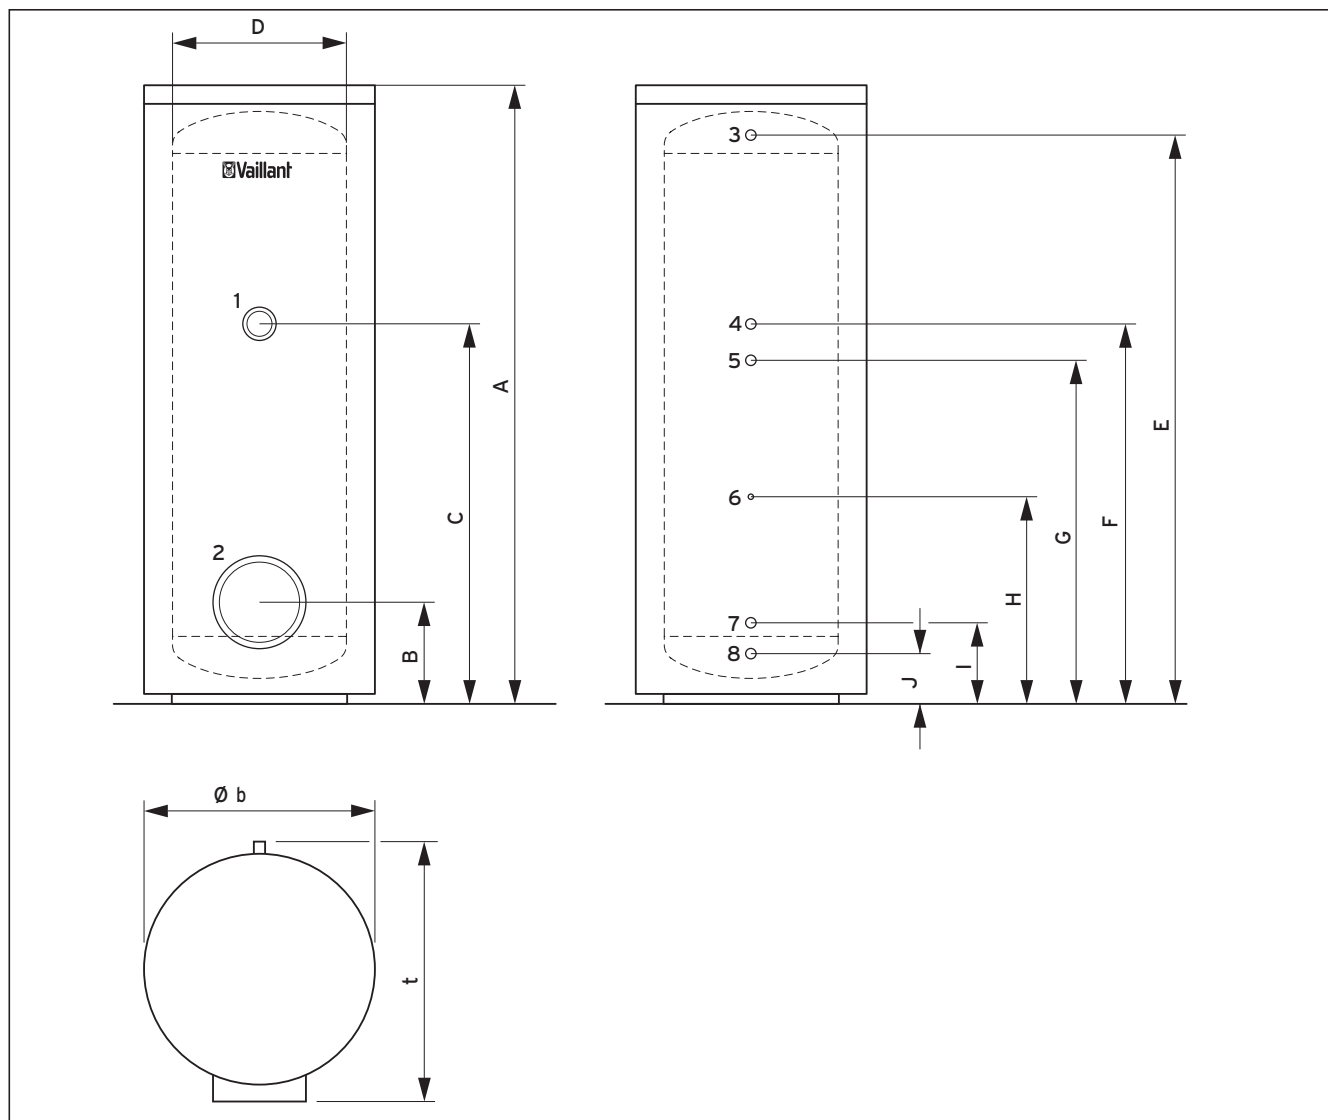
Dimensioni degli apparecchi e dei collegamenti VIH R
